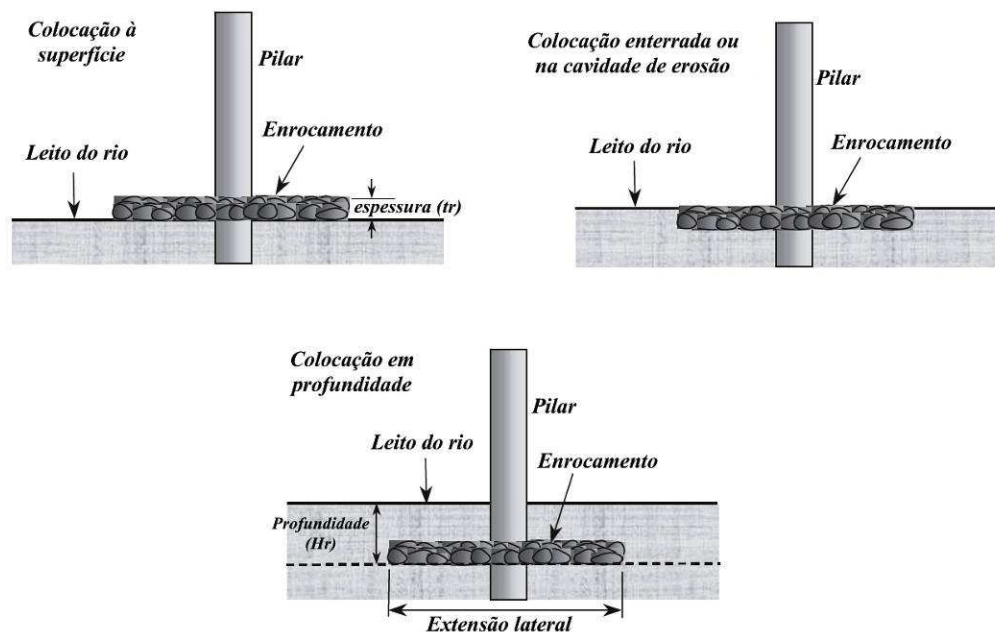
Esquema do nível de colocação do enrocamento natural num pilar (adaptado de LAGASSE ET AL. 2007).
